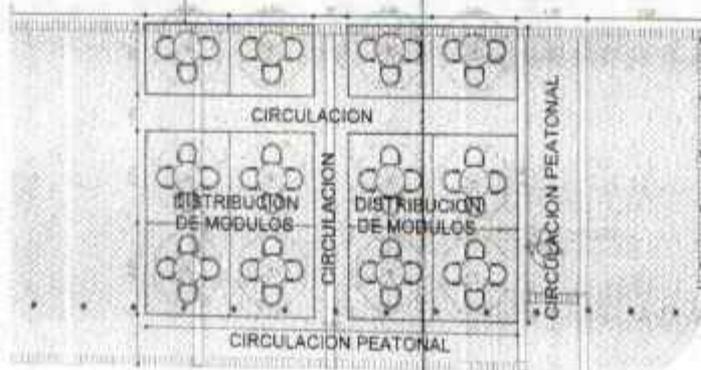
Plano PLAZA MAJAGUA -Área privada
